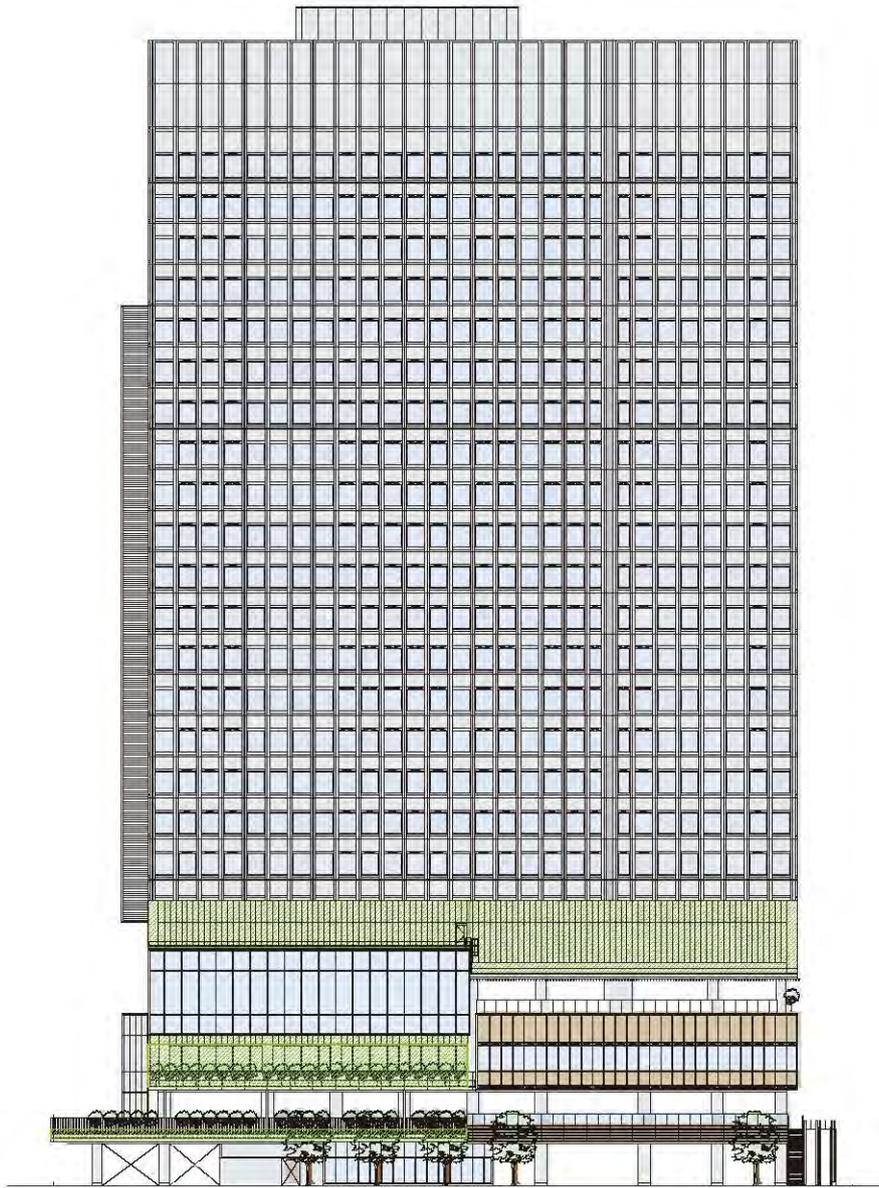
(1) 立面图 (北立面图 S=1:800)
